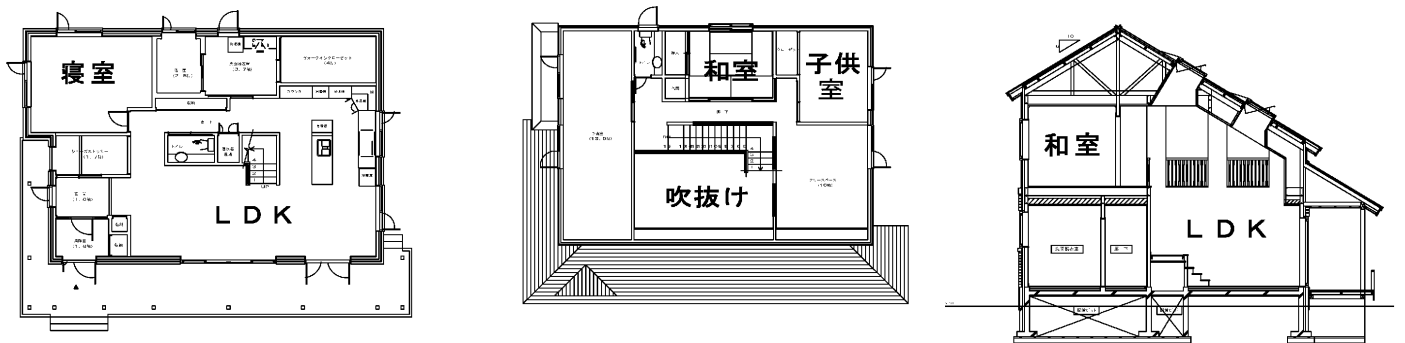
評価対象住宅の概要(一階・二階平面図、断面図)
